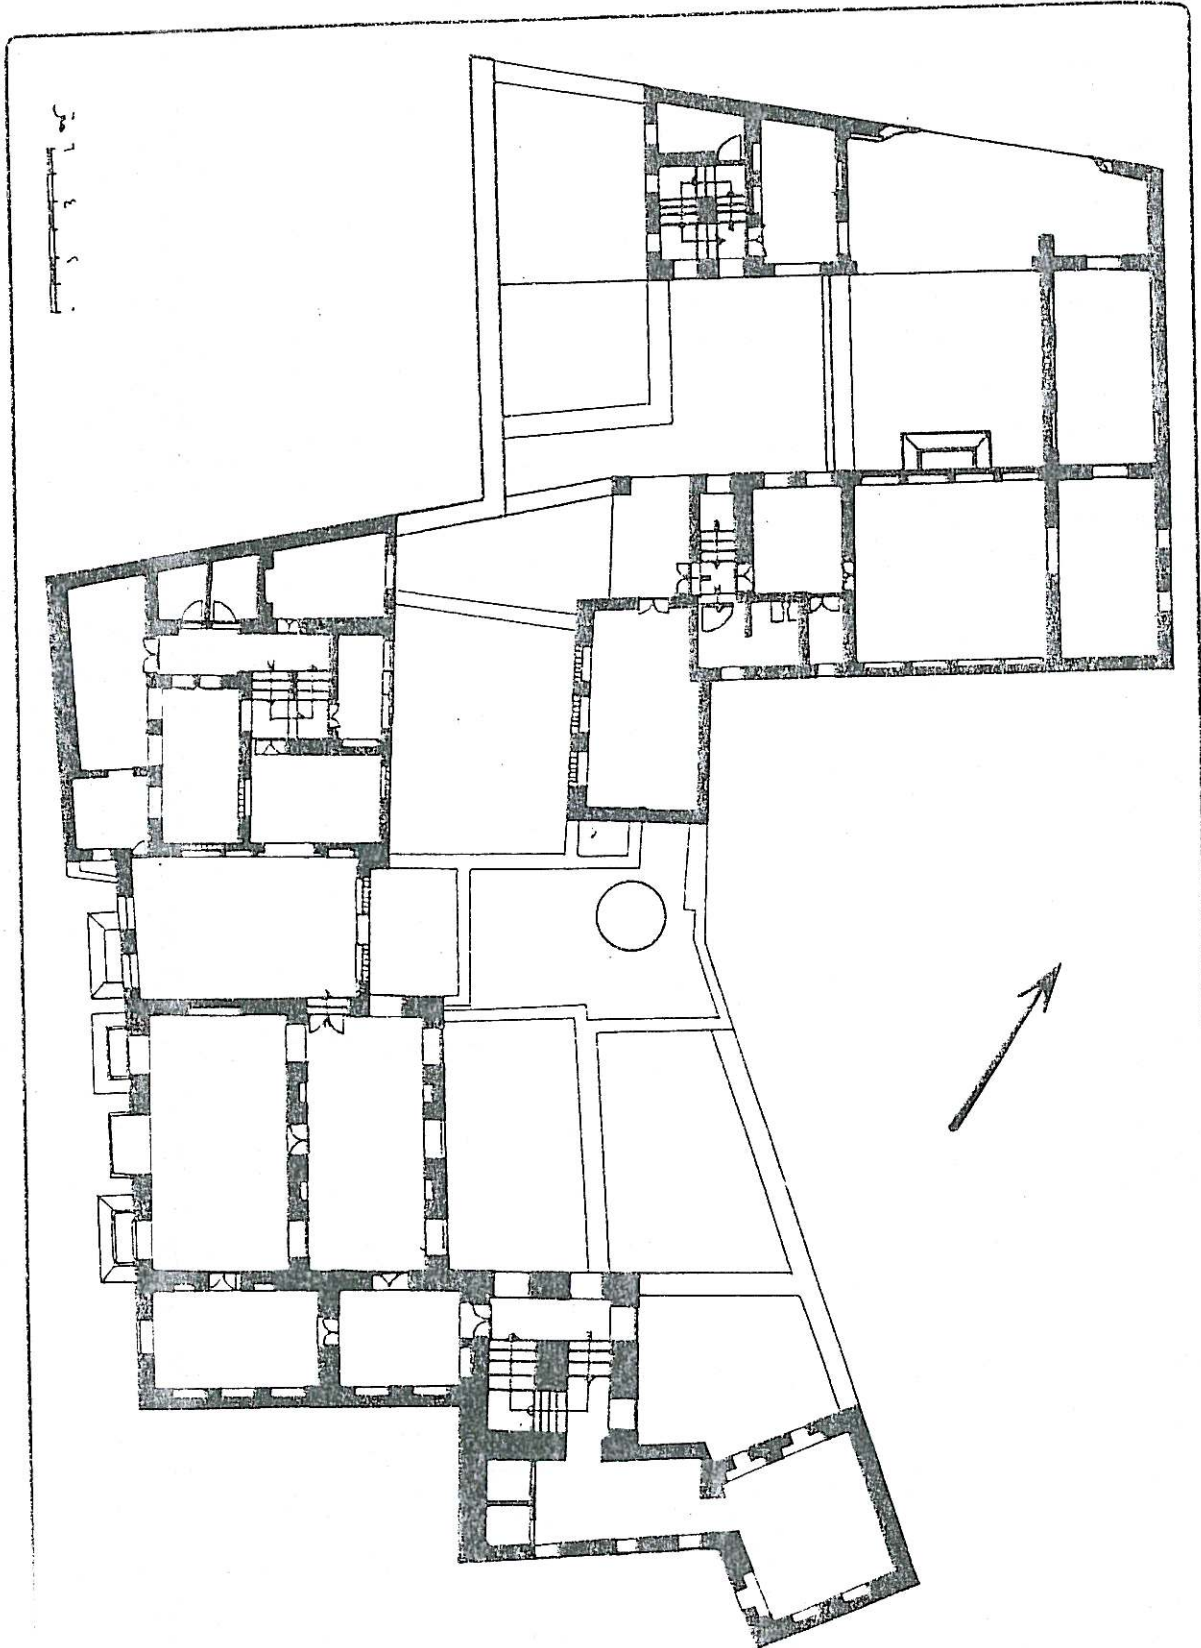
مسقط أفقي للدور الأرضي بدار الهفاء.
